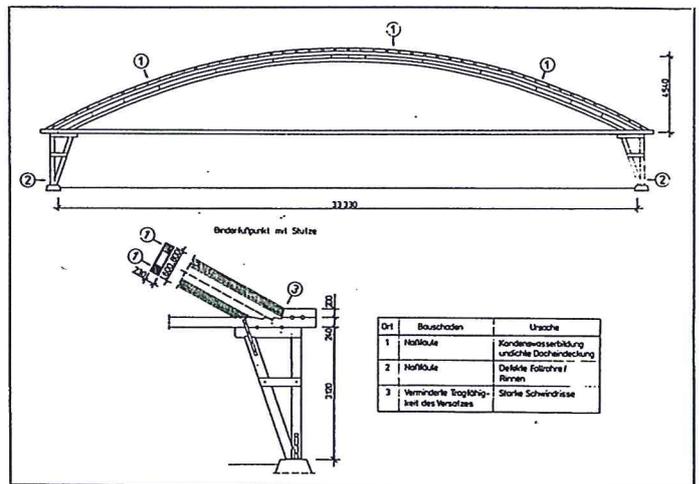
Bogenbinder einer Produktionshalle 35,0 m × 56,5 m, Baujahr 1941
